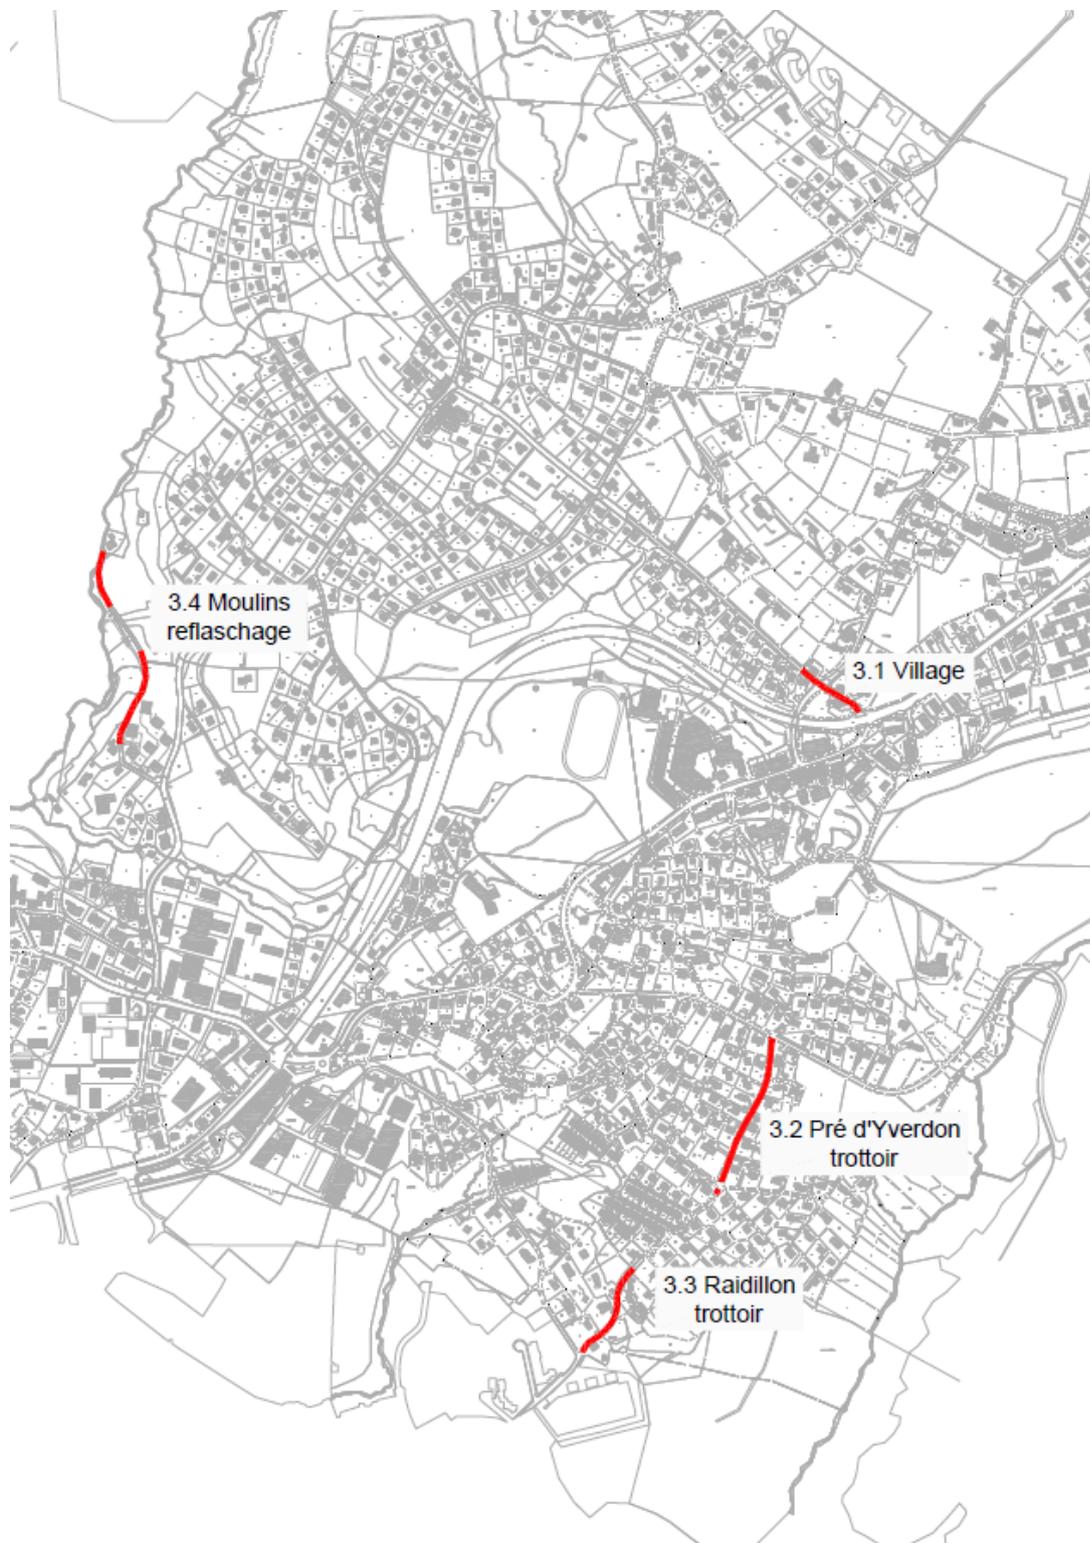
Plan de situation avec l'ensemble des travaux projetés
